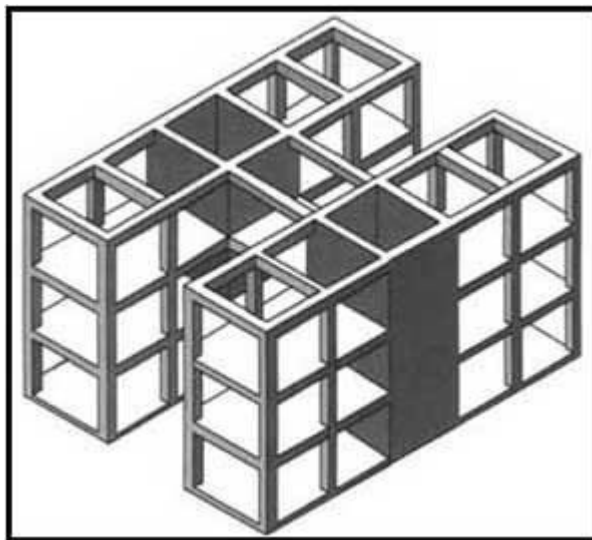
Sistema constructivo a porticado Fuente: Blog casas prefabricadas
